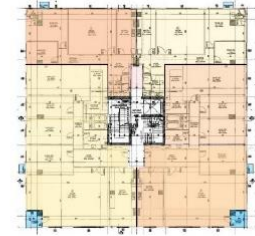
Farklı Dönemlerin V. Planlarında Bodrum Kat - Bahçe Alanı Karşılaştırılması
